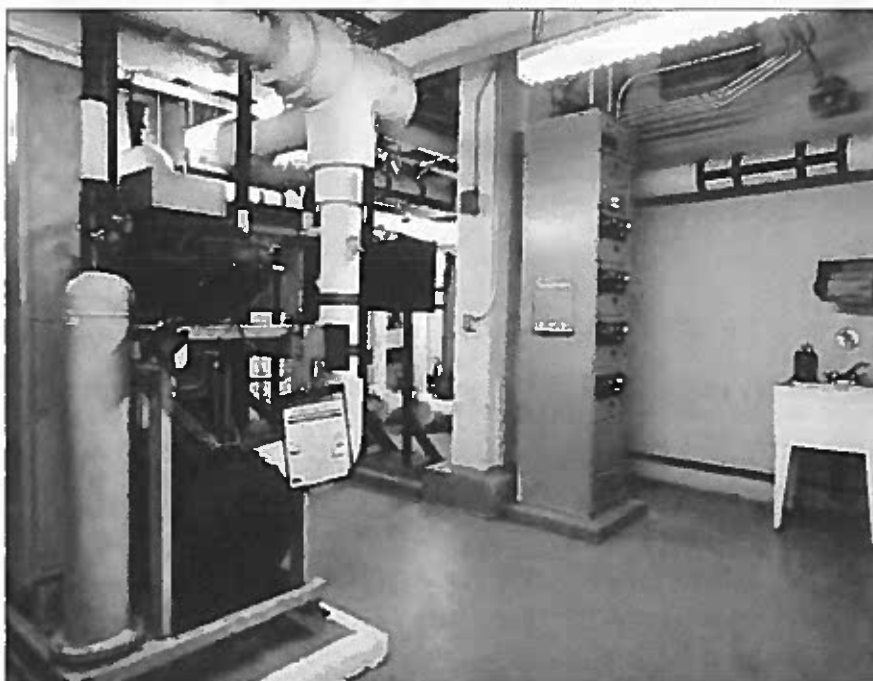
Sous-sol, Salle mécanique – Mur recouvert d'une peinture blanche au plomb (échantillon 02) et plancher recouvert d'une peinture grise (échantillon 07)
